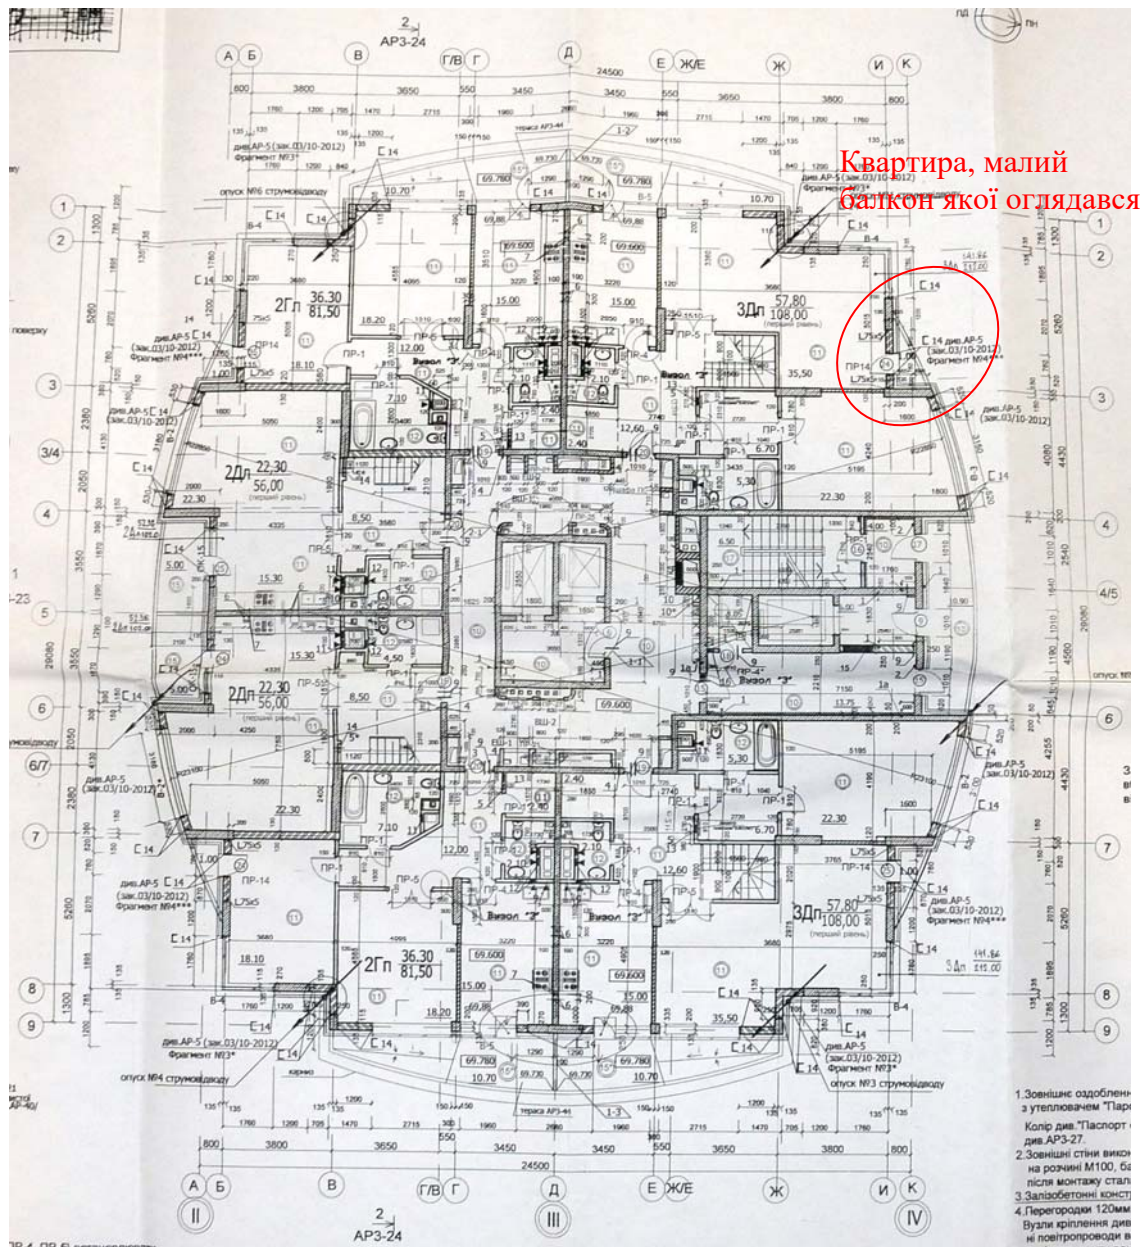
Схема розміщення фрагменту будівлі, що оглядався, (24 поверх).
